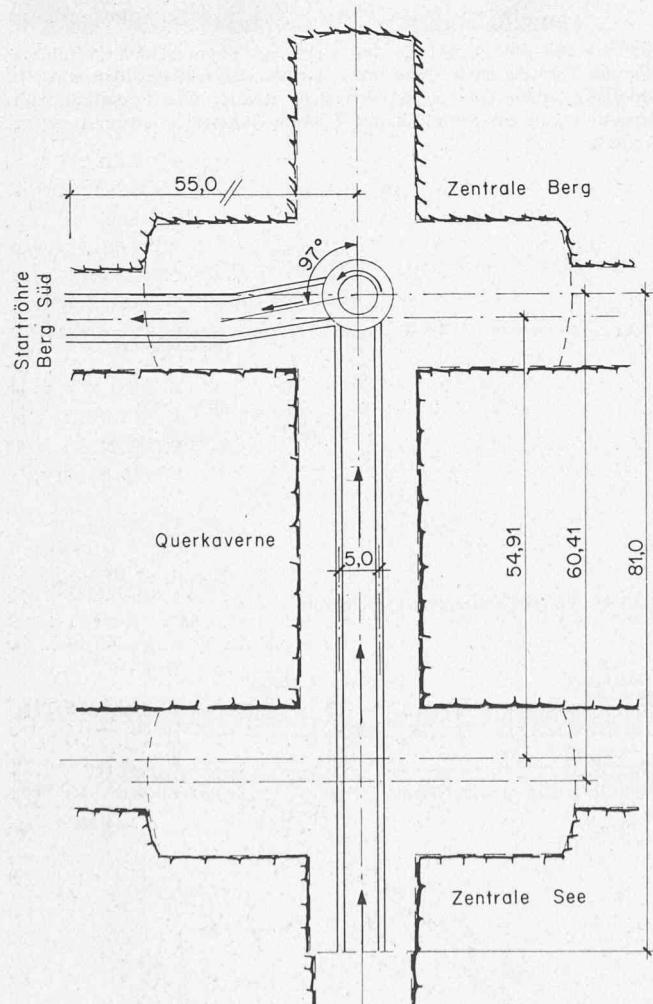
Grundriss der Zentrale im rohen Ausbau mit Situation der für die erste «Big John»-Ummontage notwendigen Verschiebebahnen in der Quer- und Bergzentrale sowie des Drehtisches in der Zentrale Berg
